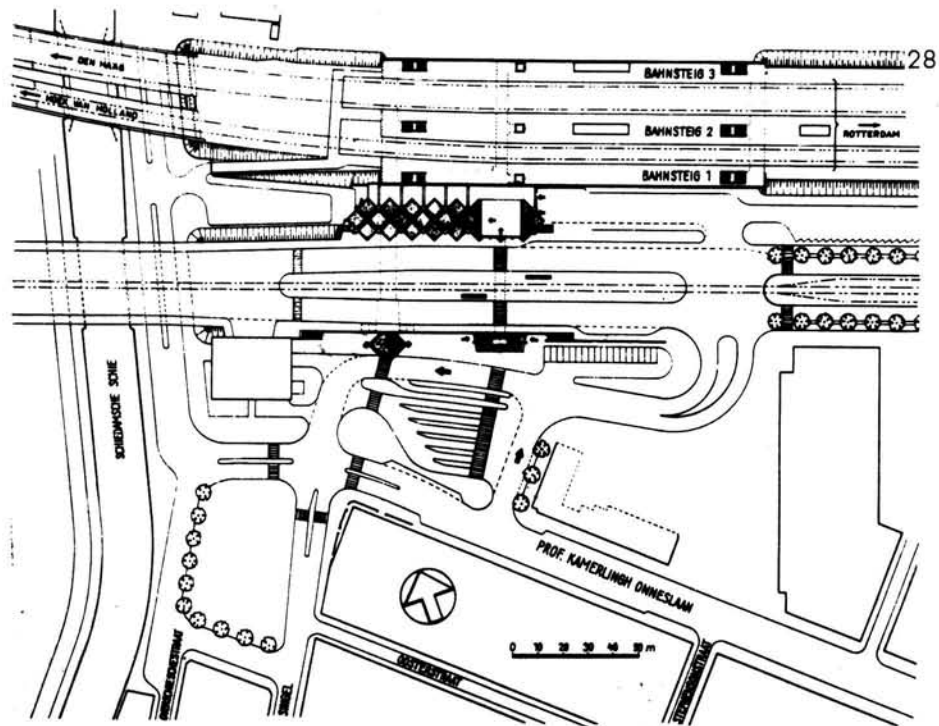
Lageplan der Bahnhofsanlage in Schiedam.
